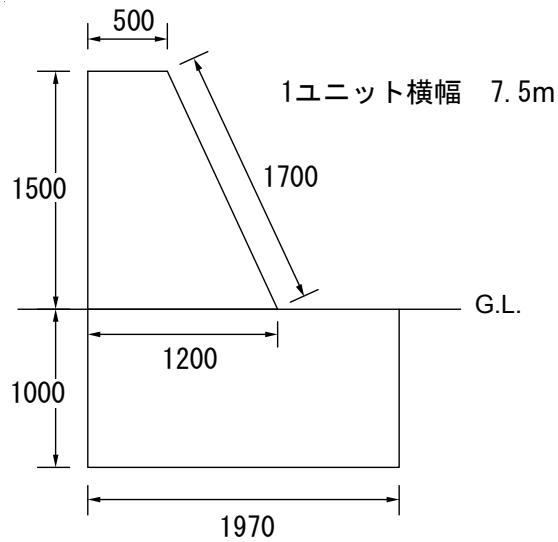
転倒していない堤防断面図 (単位: mm)
